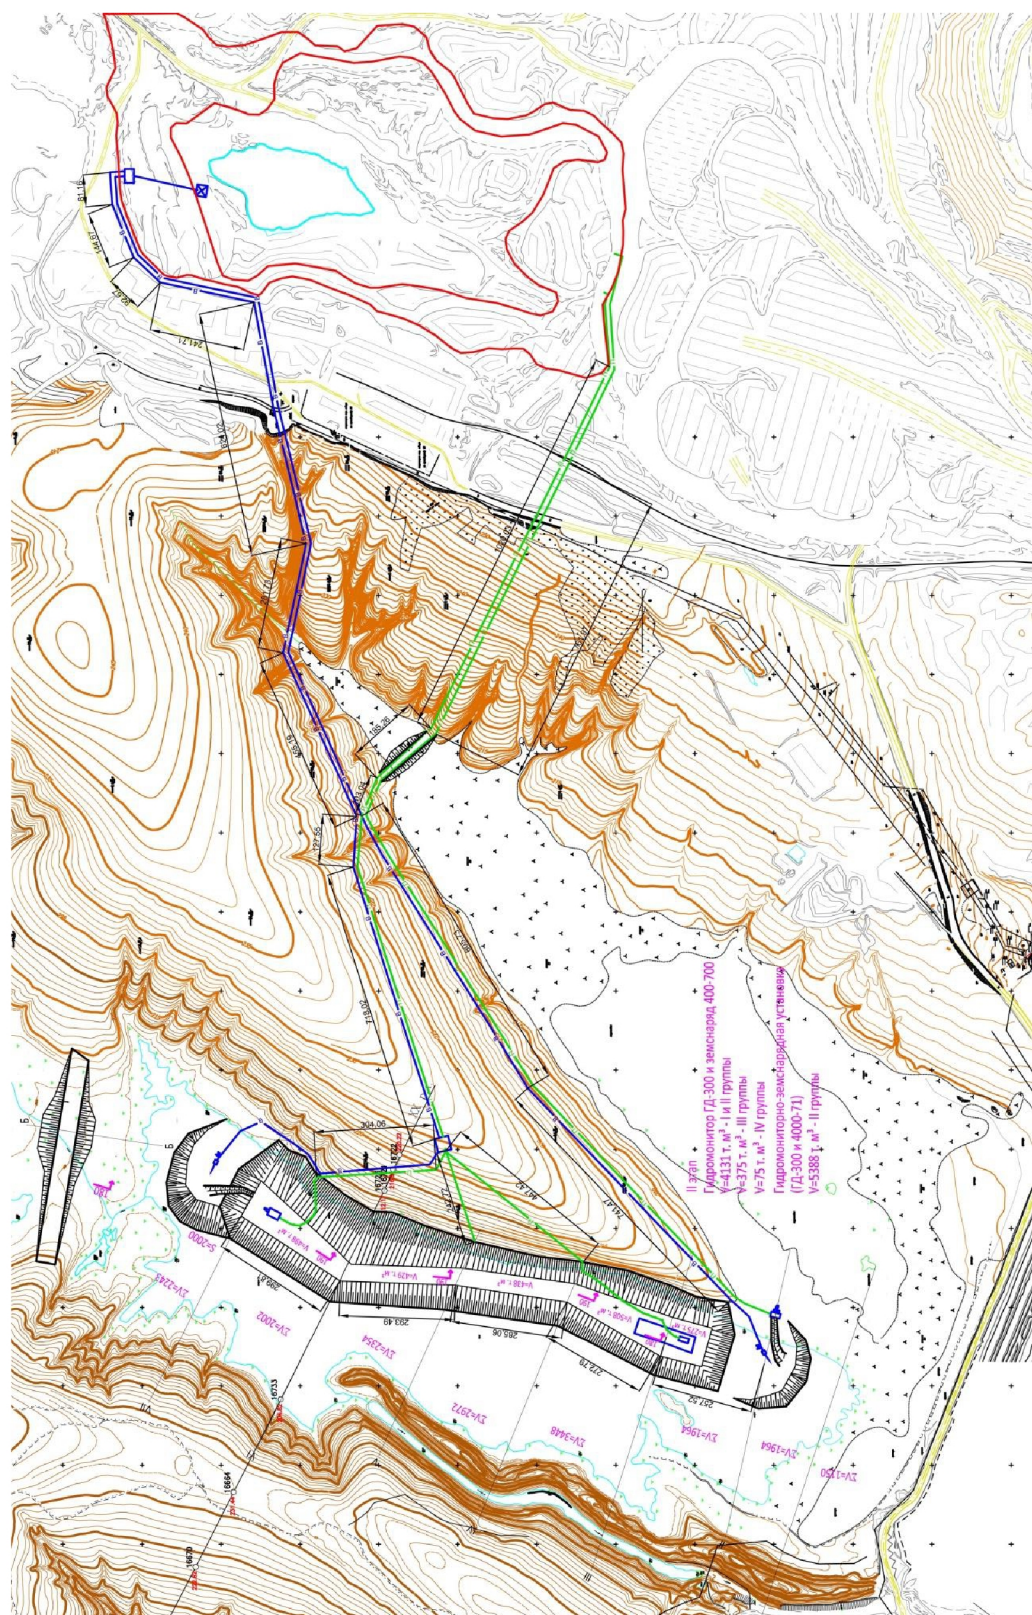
План горных работ на период ввода в эксплуатацию гидромониторно-земснарядного и гидромониторно-землесосного комплексов для разработки пород, намывных ранее в гидротвал №2 разреза «Черниговцев», и перемещения их на новое место укладки
